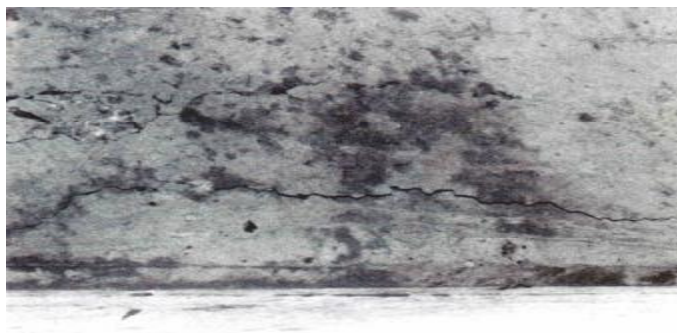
钢筋锈蚀引起开裂
